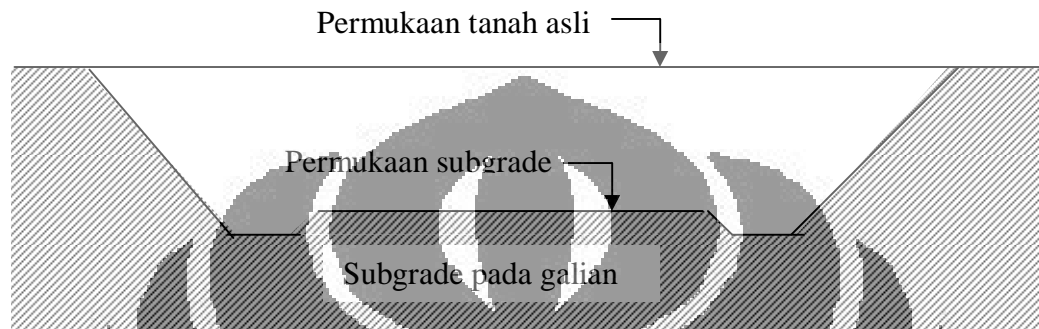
Kondisi Perkerasan Lentur Berkaitan dengan Lapisan Pondasi
